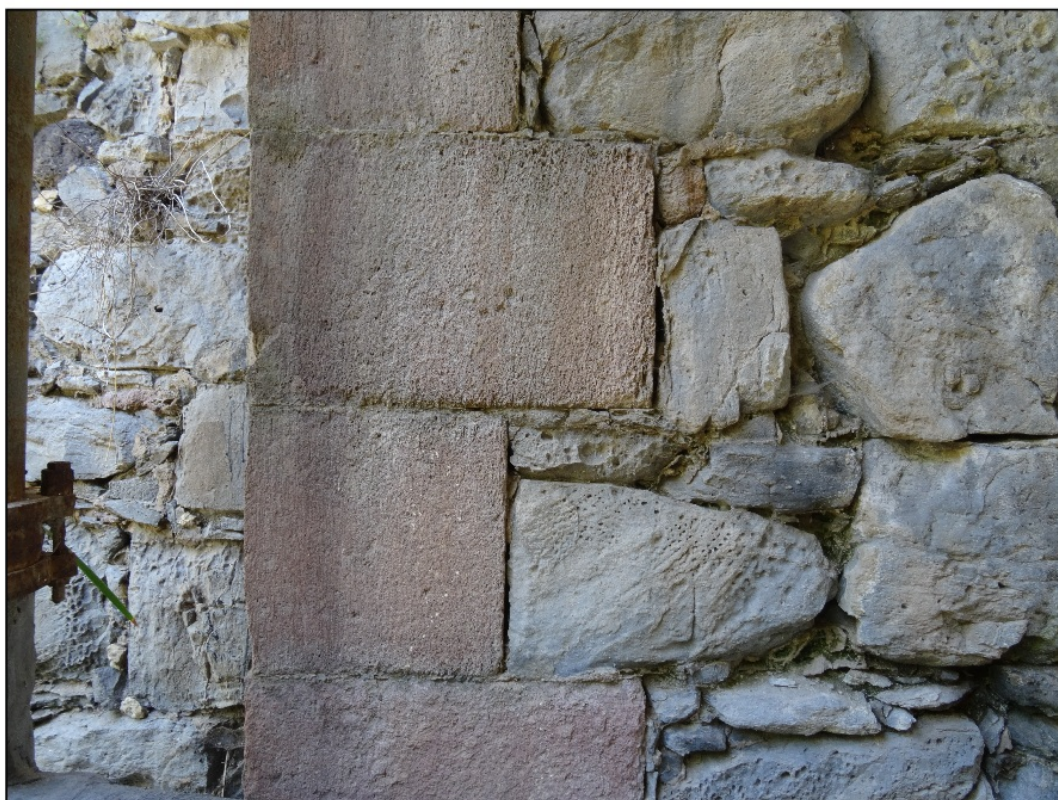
Il ponte sulla SS 292. Particolare costruttivo
